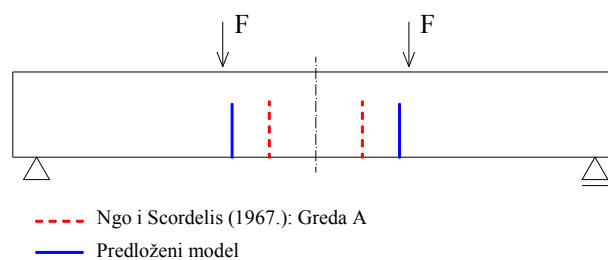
Naprezanja prijanjanja za različite obrasce raspucavanja
